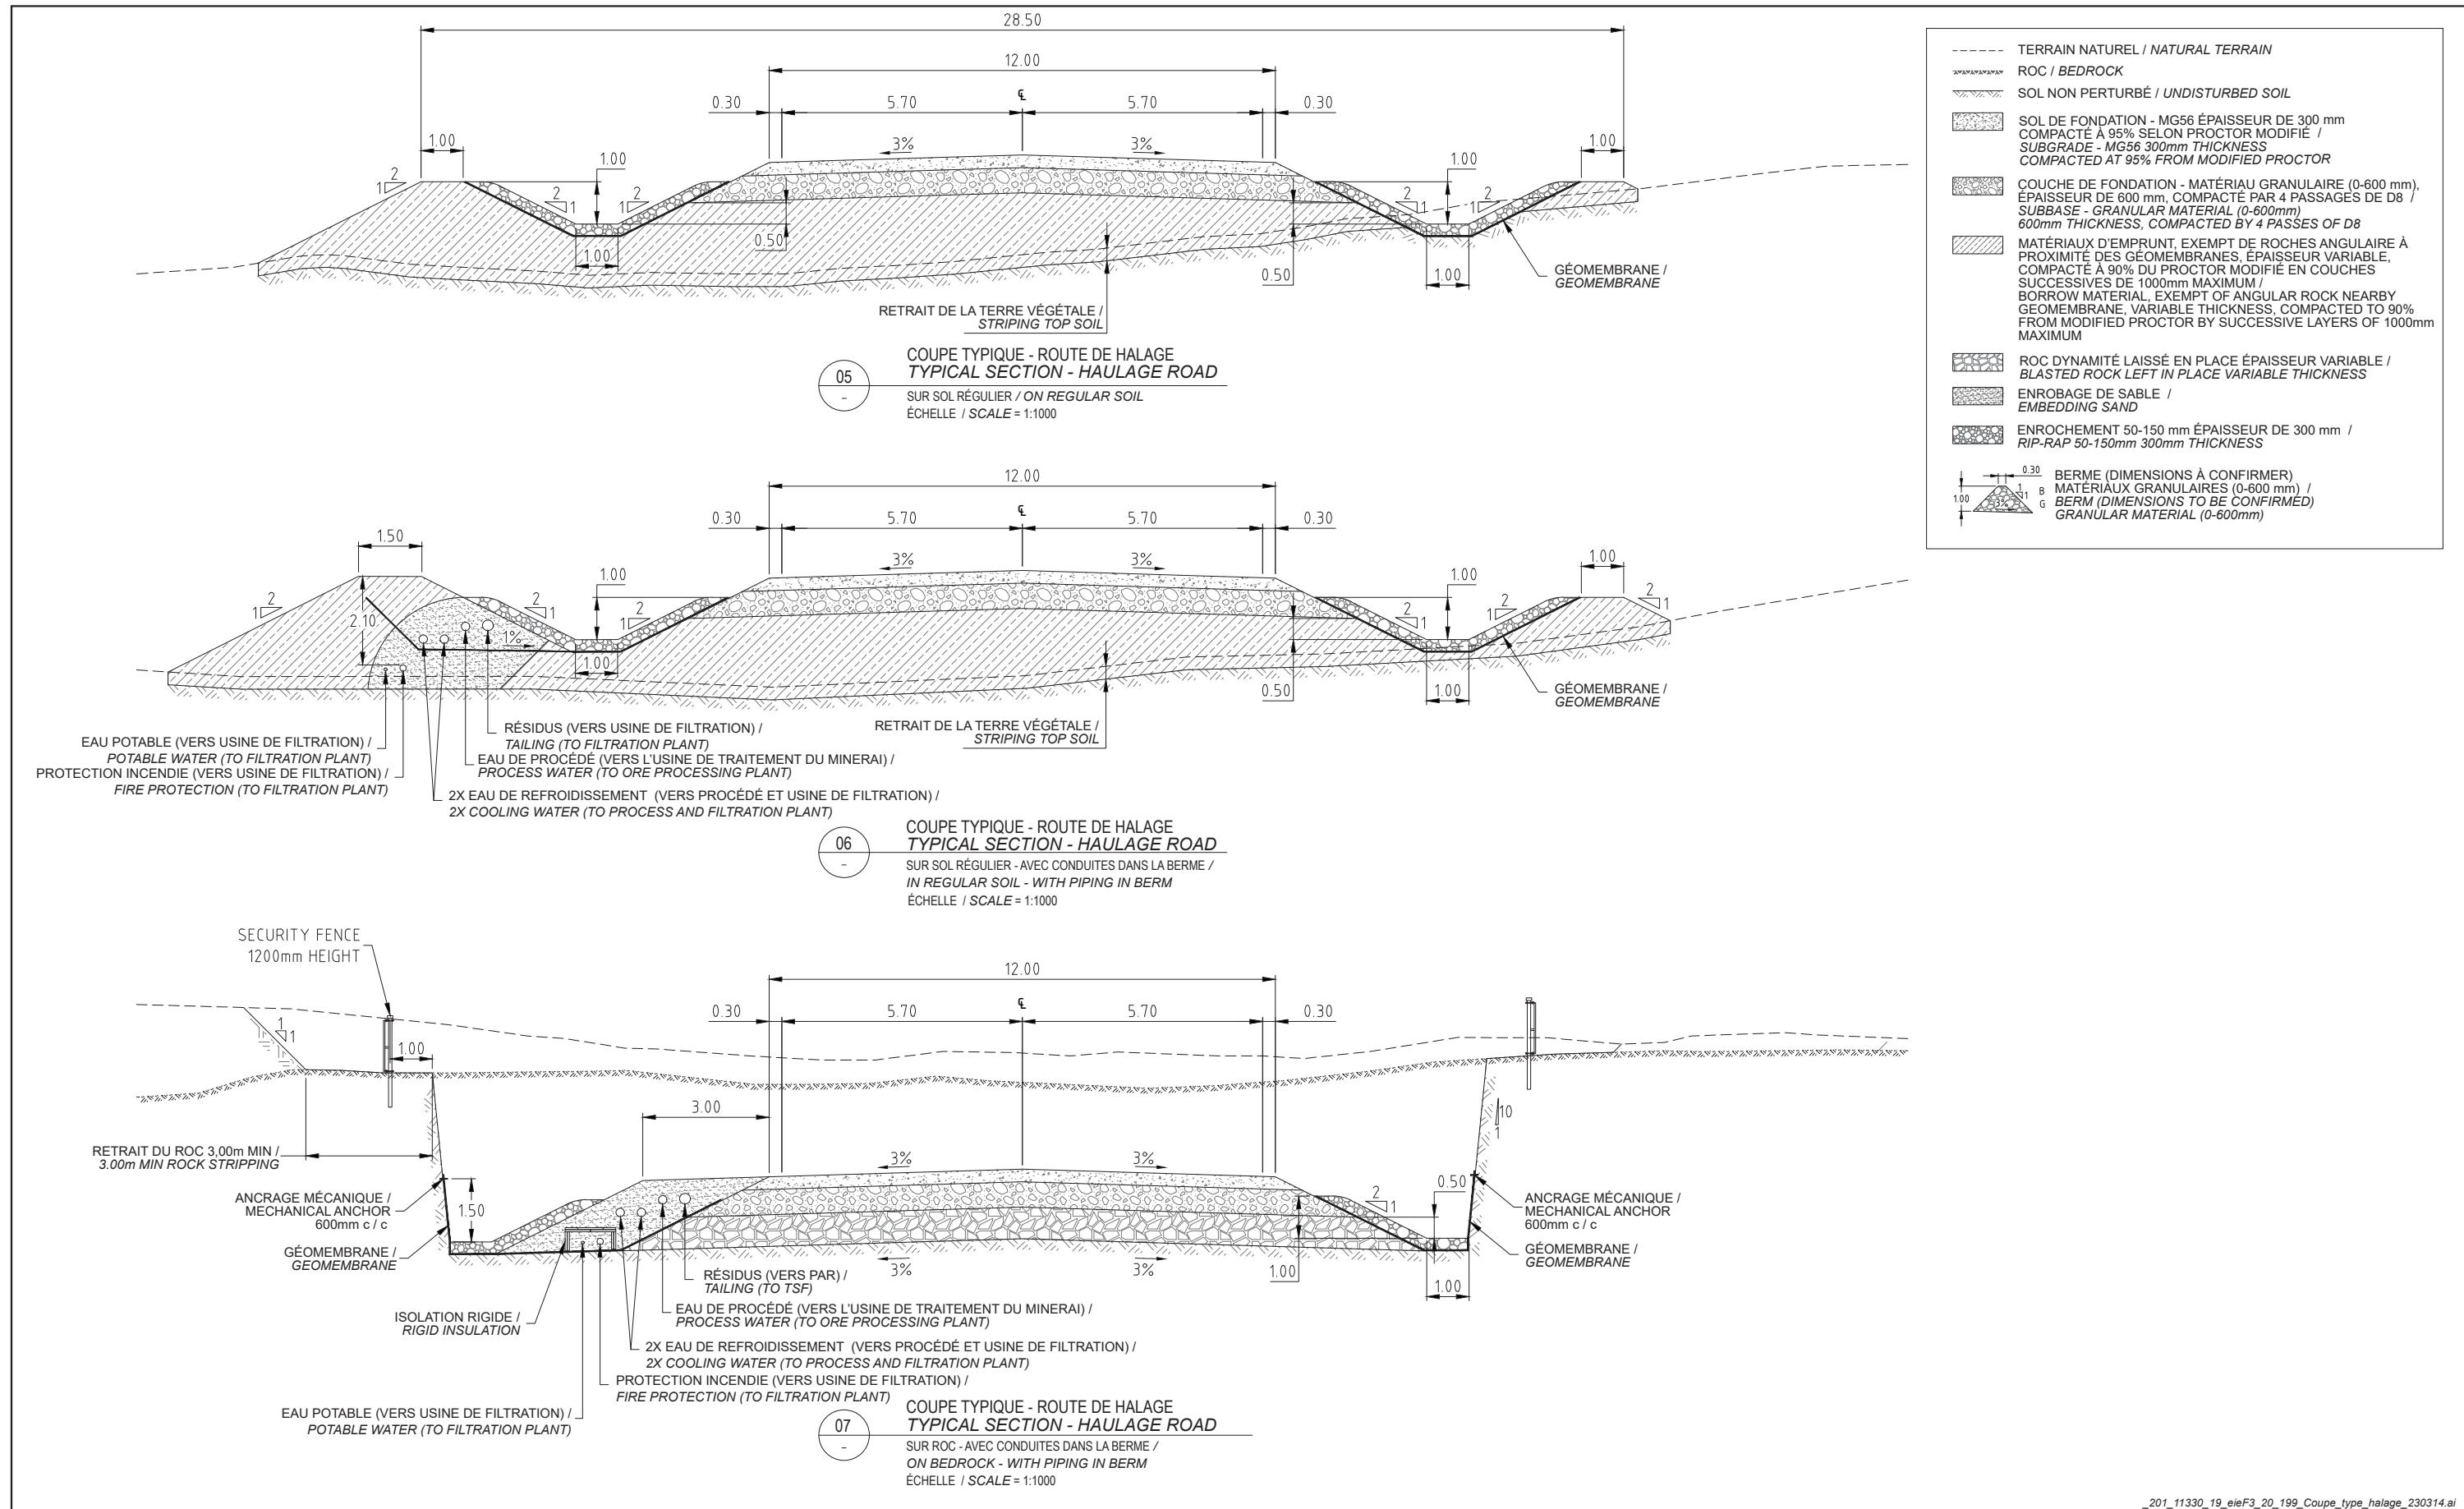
Coupe-type d'une route de halage / *Hauling Road Typical Cross-Section* (réf. Modifié du plan émis par WSP pour Osisko (515-C-0601-ZA))
